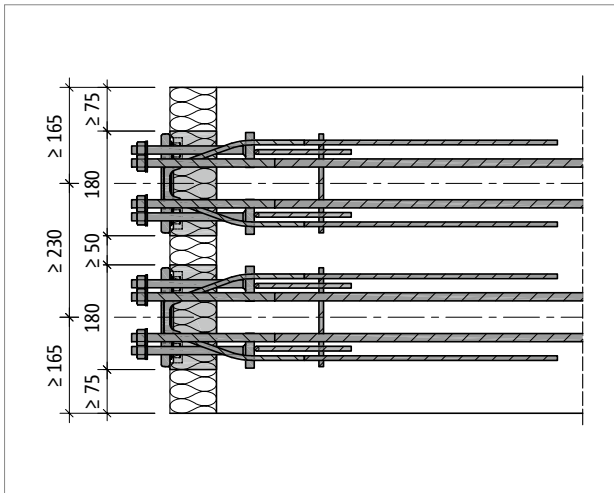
Schöck Isokorb® T type SK : Entraxe
